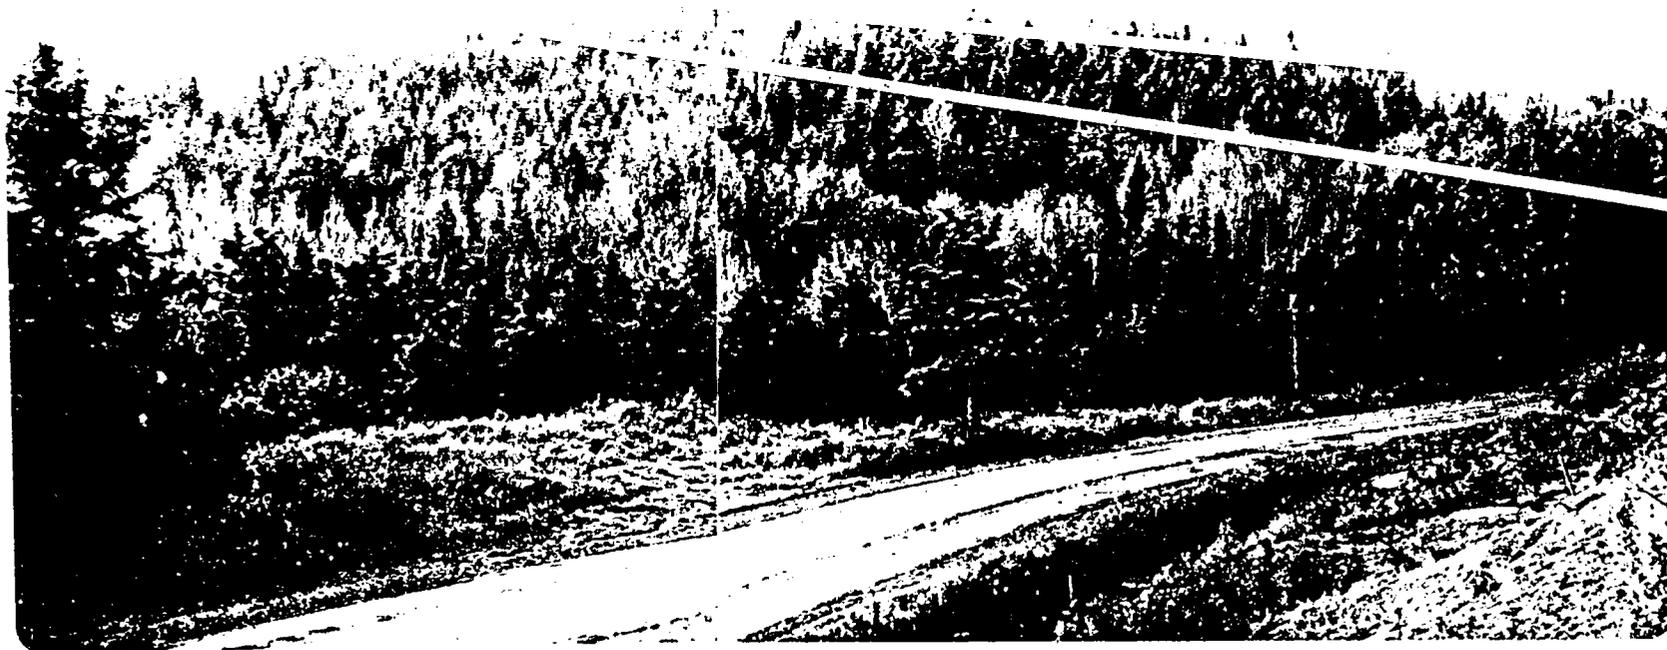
Rivière Gilbert, site prévu pour la construction du pont (chaussée ouest). Un remblai important sera effectué à cet endroit.
